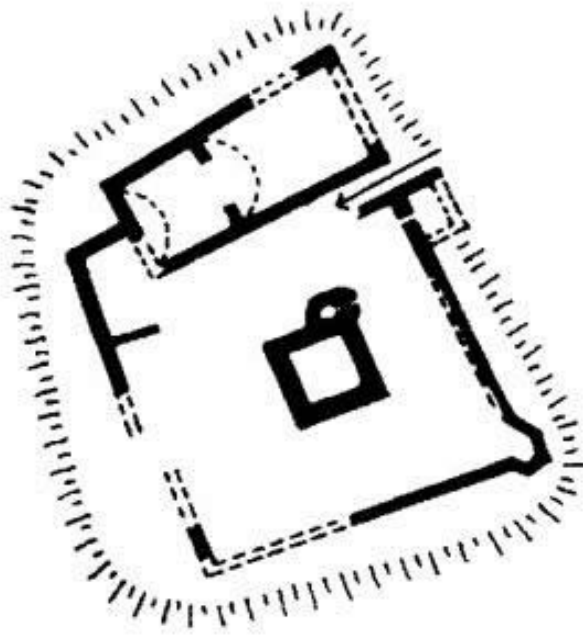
Grundriss der Tiefburg Stuer.
